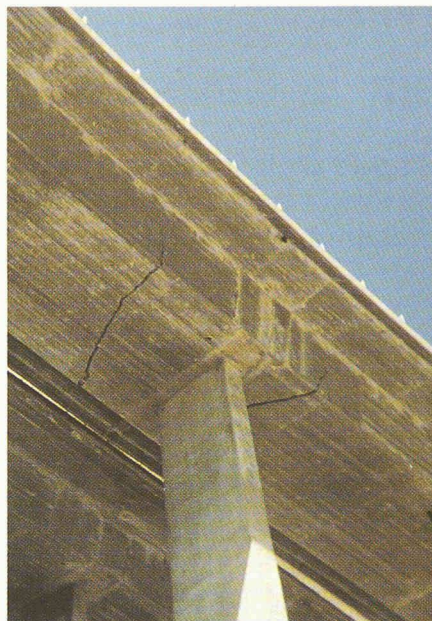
Le pont sur la Reuss à Wassen, fissuration du tablier par affaissement des fondations. (Photo: R. Kalbermatten.)
